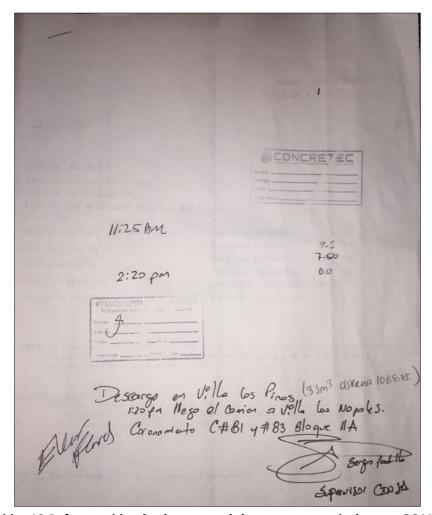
Información de descarga del concreto enviado por CONCRETEC
